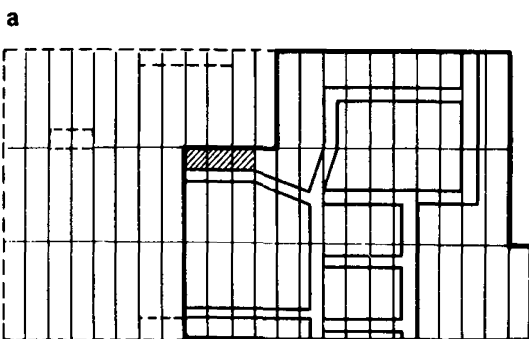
Зоны возможного размещения мест отдыха на плане промышленного здания
